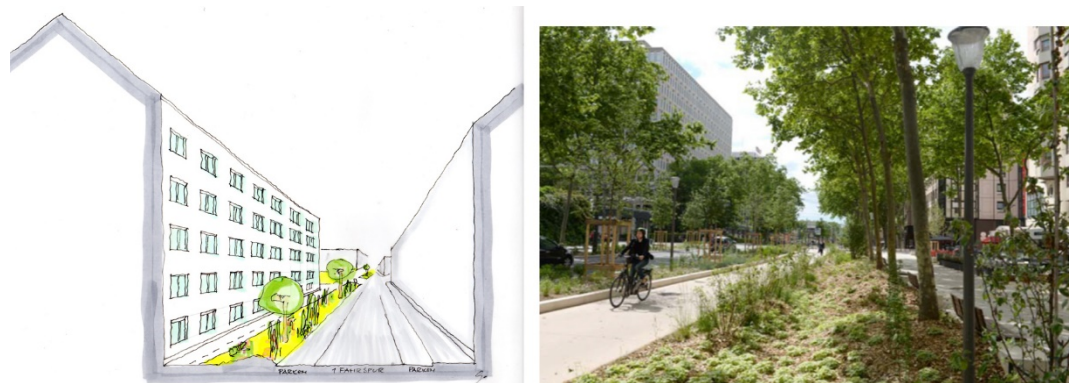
Links - Straßentrückbau und Fassadenbegrünung mittels Balkontrögen (Skizze und Idee Team Spitaler), rechts - Beispiel eines Straßentrückbaues—Rue Garibaldi, Lyon
